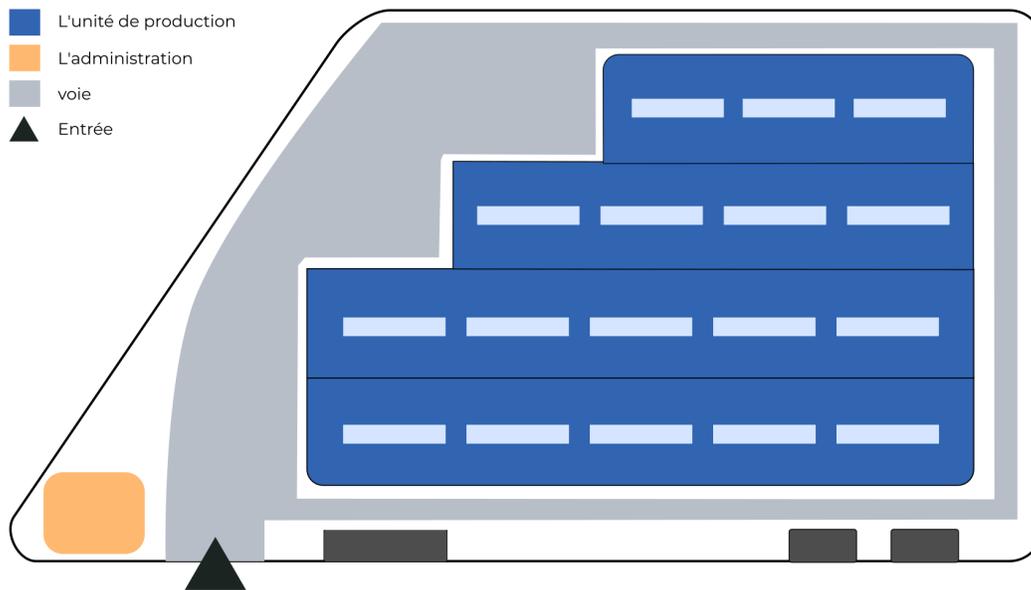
Plan de masse de l'usine d'Oran
